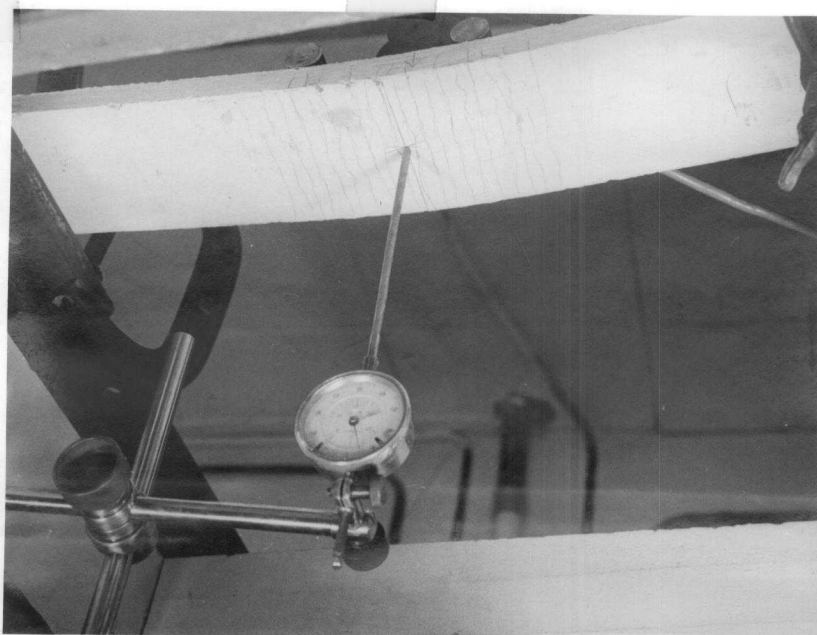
Detalhe das fissuras de uma Faixa por ocasião de um ensaio.
